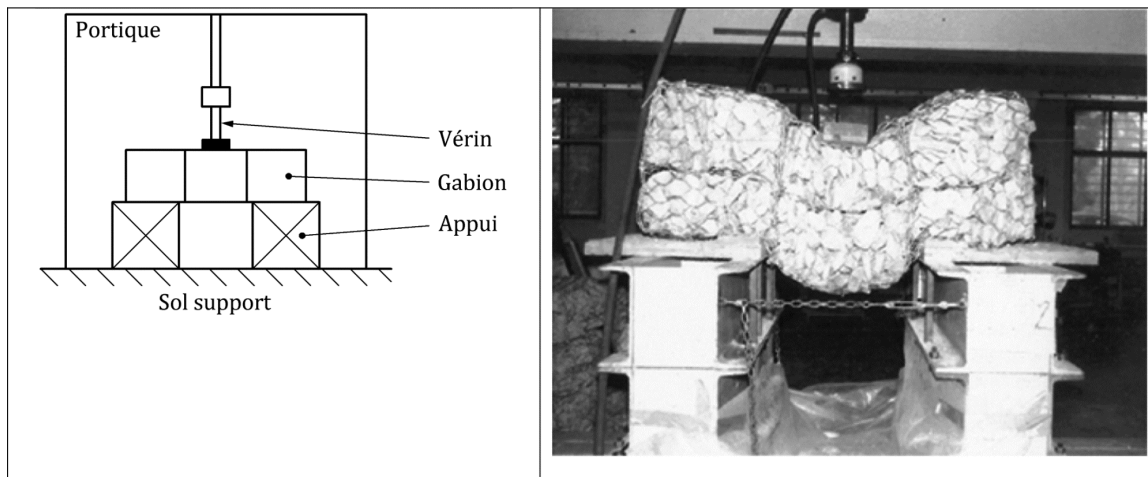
Exemple de dispositif permettant la mesure des paramètres f_c et c_c
